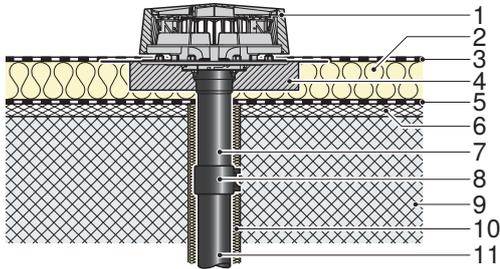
Монтаж на изолированной жесткой кровле с кровельным покрытием
